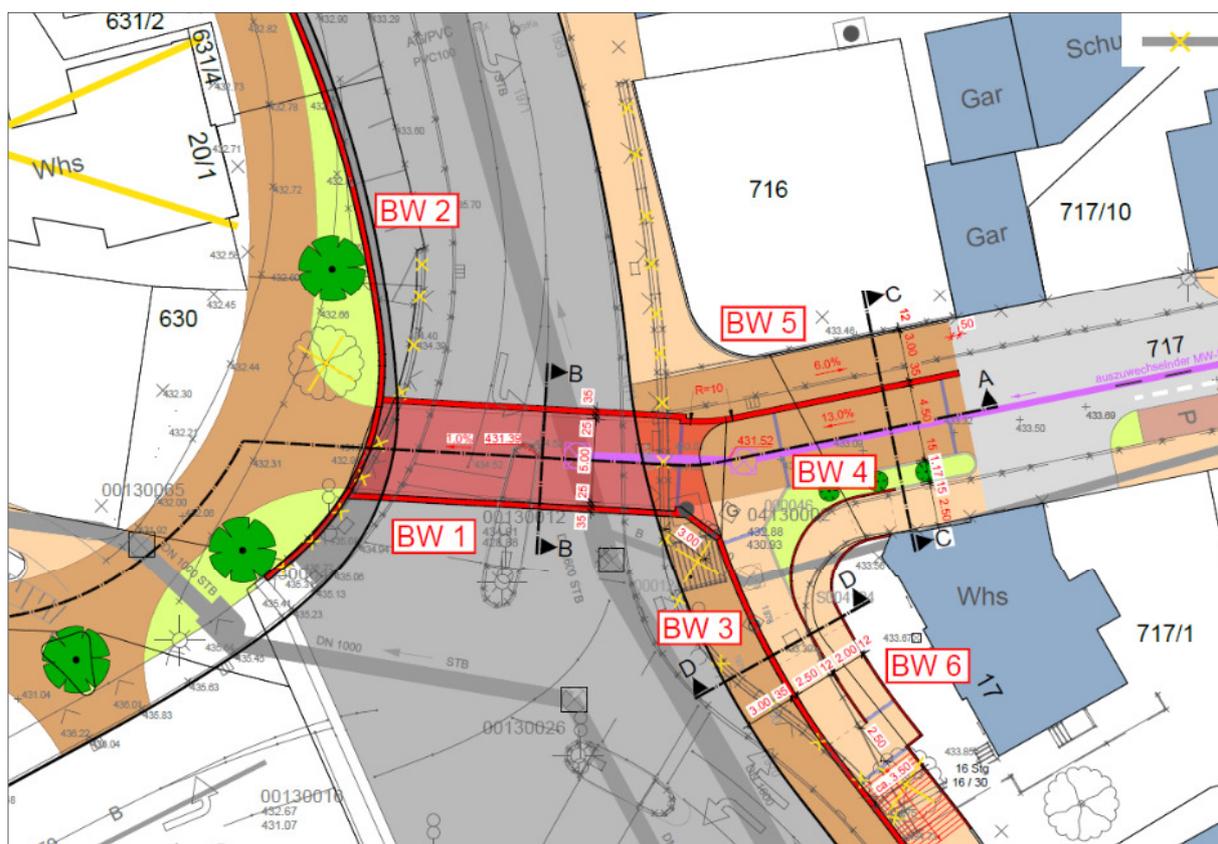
Bauwerksplan Geh-/Radwegeunterführung Kettelerstraße
